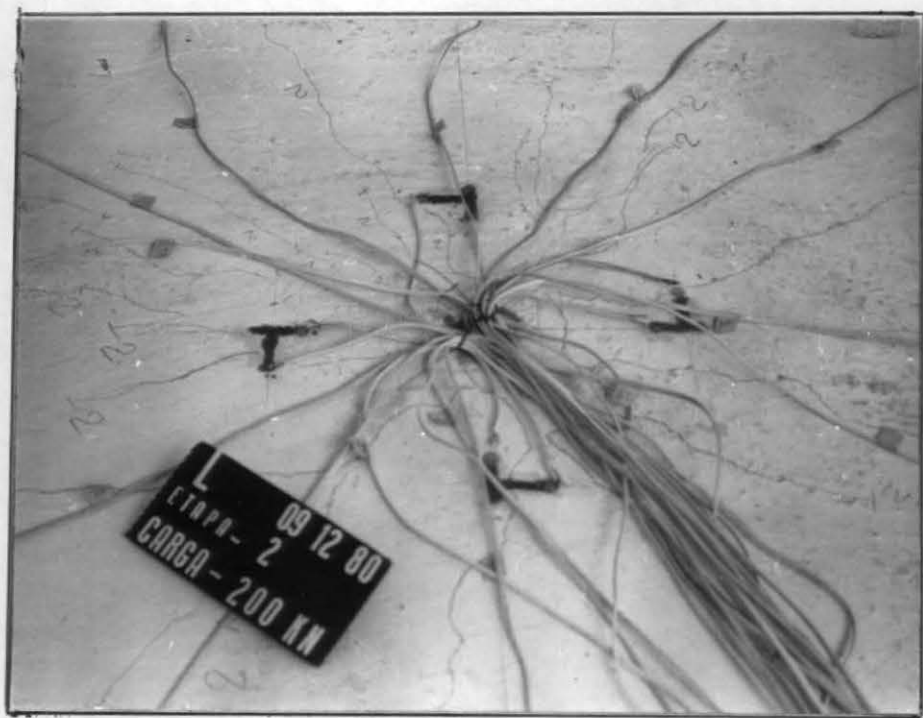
Configuração das fissuras - laje L2
